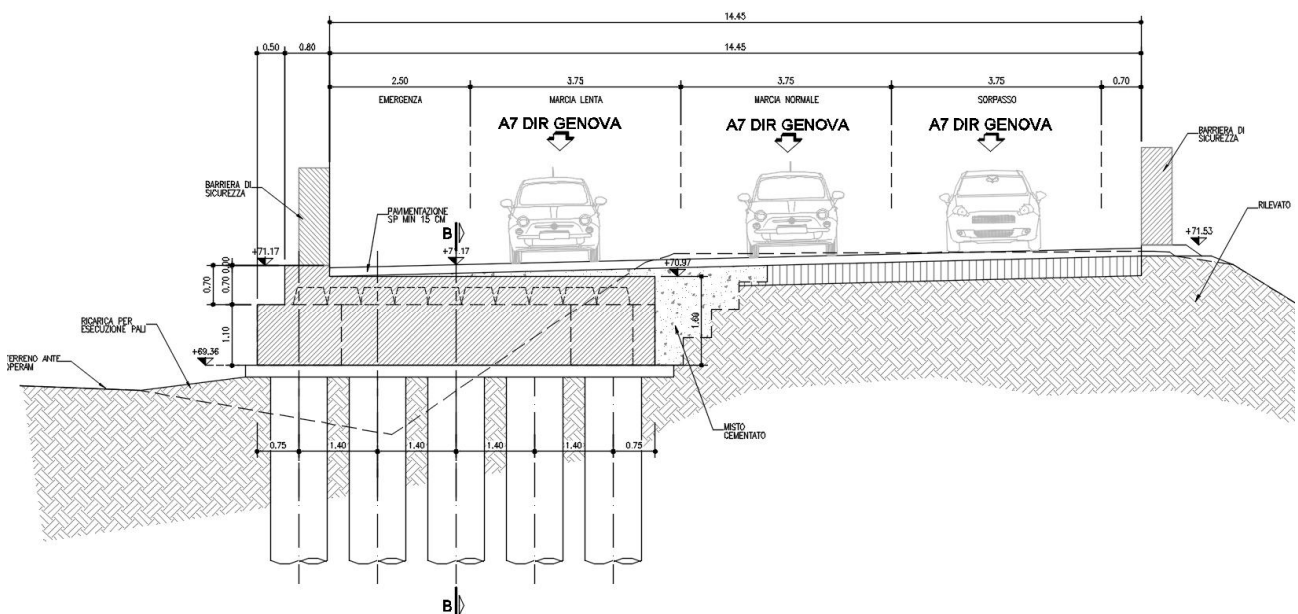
Spalla lato Milano - Sezione trasversale zona impalcato
